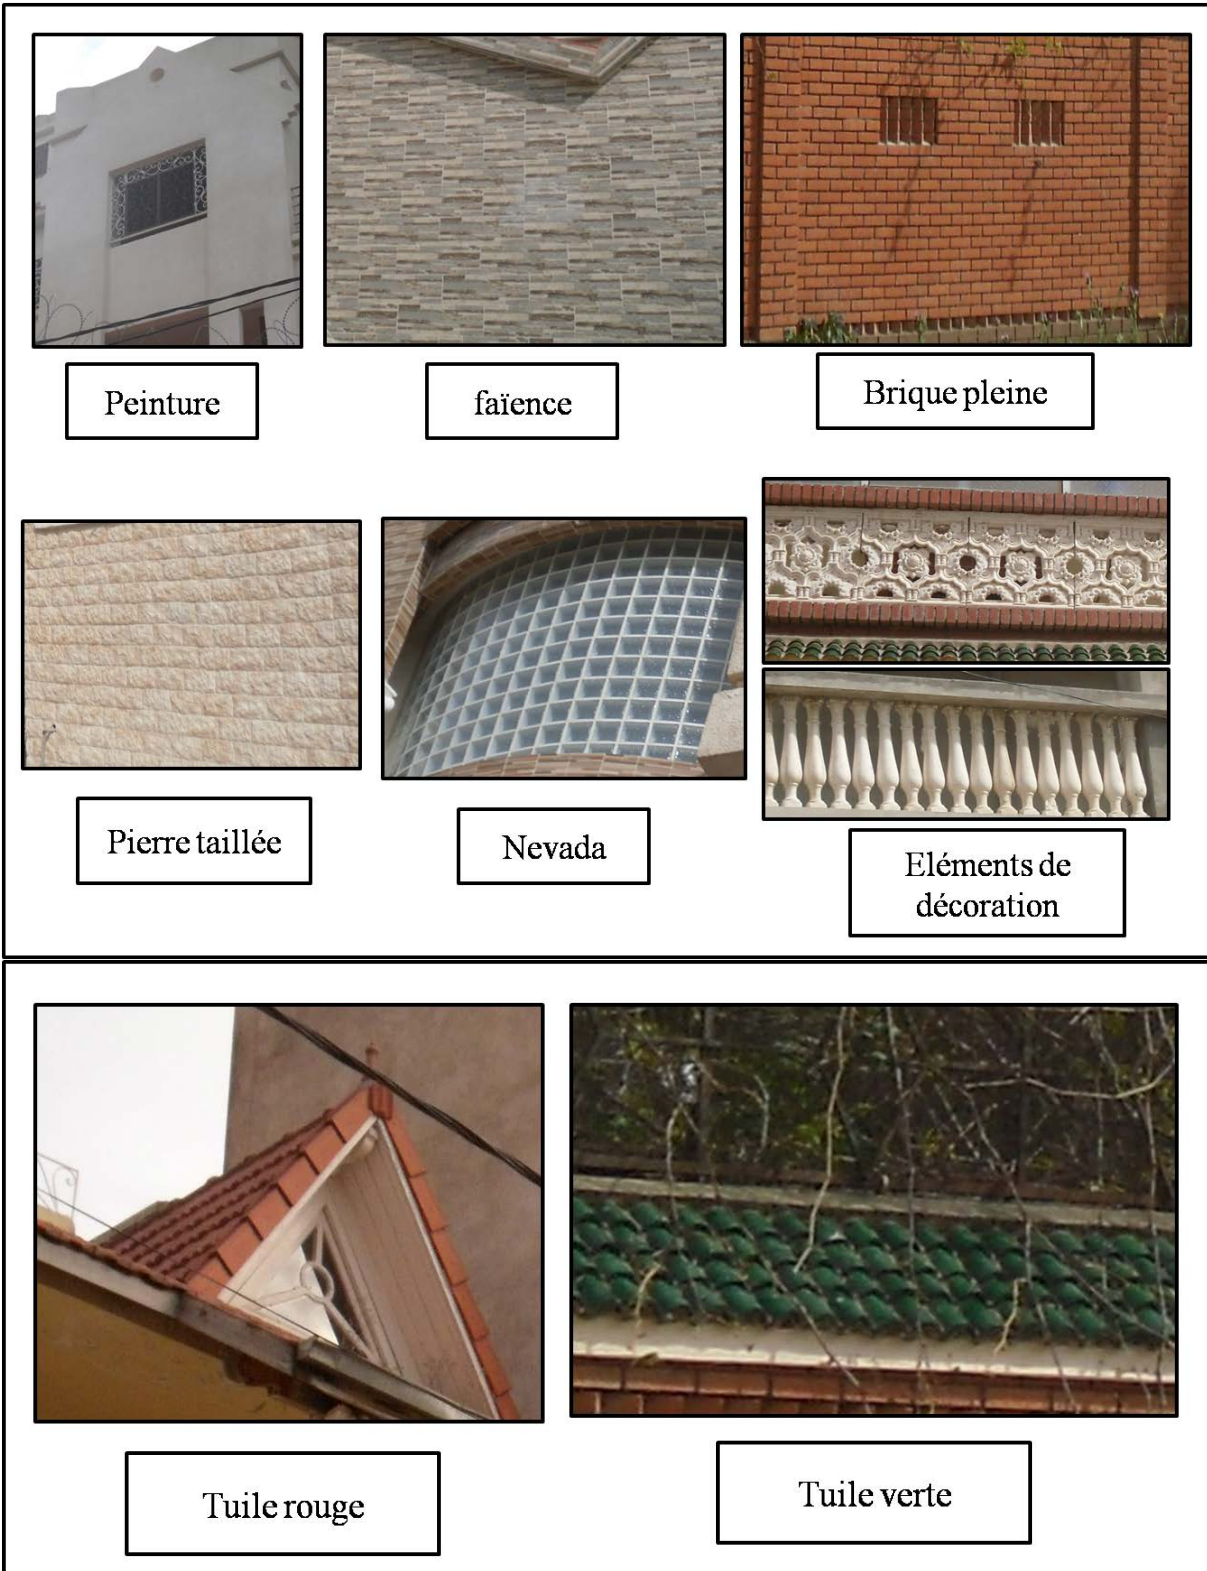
,71: Images présentant les matériaux de construction (Source : l'auteur 2013)
